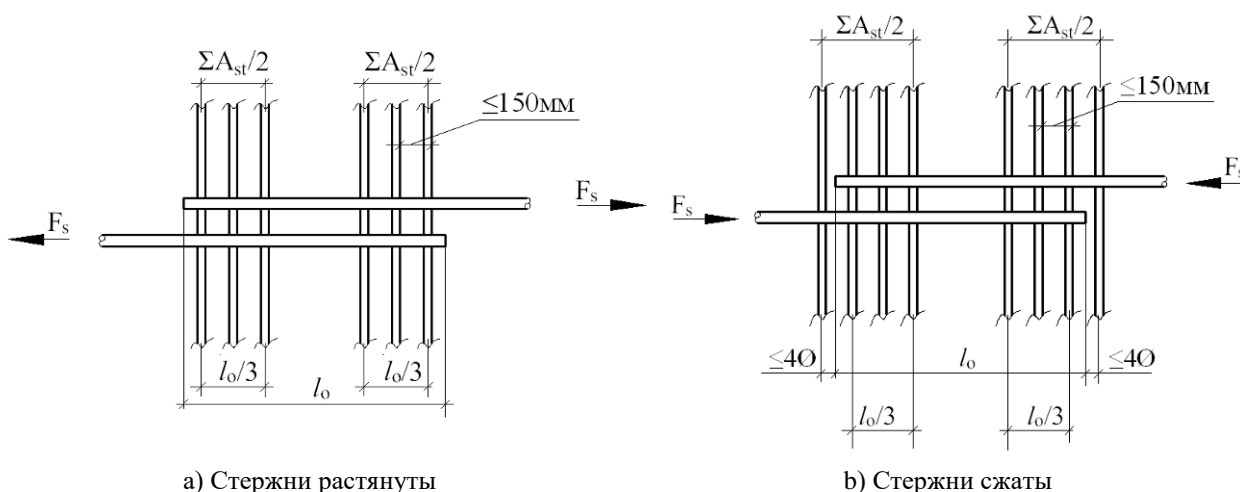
Поперечная арматура для анкеровки стержней, соединяемых внахлестку
